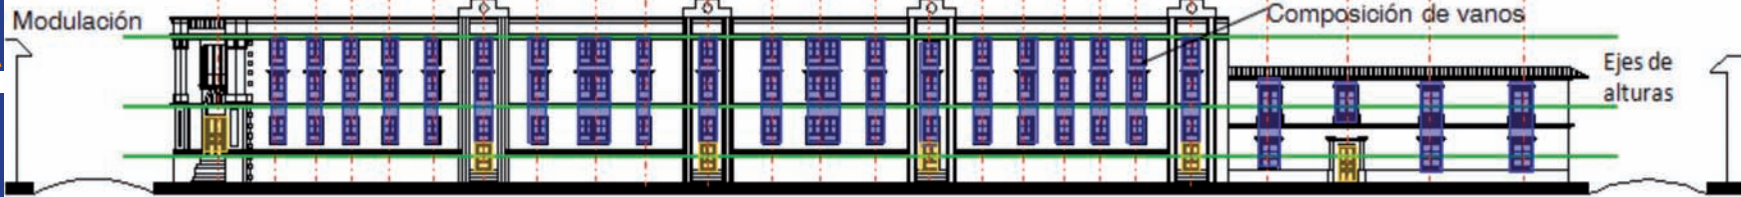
//Levantamiento de fachada, Calle 19 entre carreras 22 y 23 - área de estudio//
